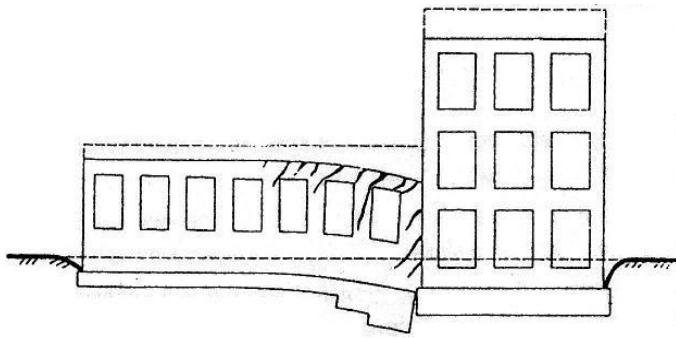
Вплив зведеної будівлі на нерівномірне осідання існуючої будівлі
